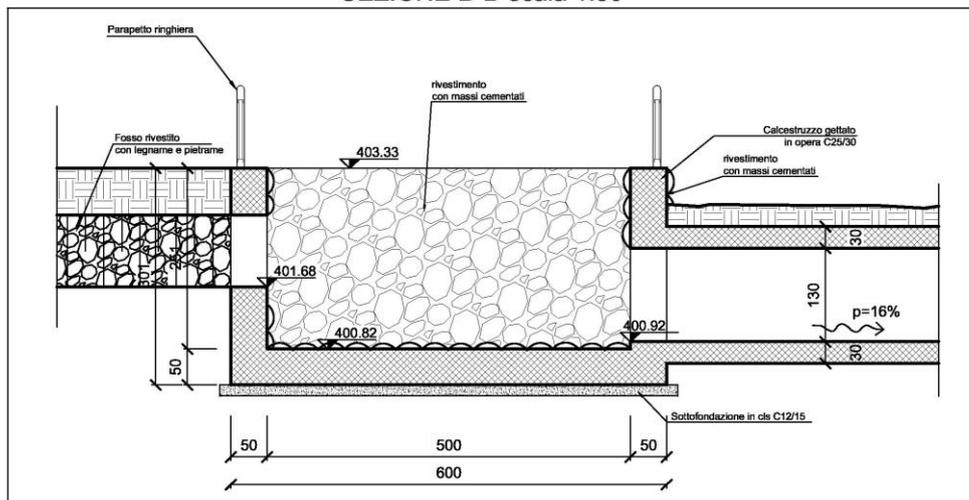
Sistema compluvio sud – Vasca Vs12 - sezioni
